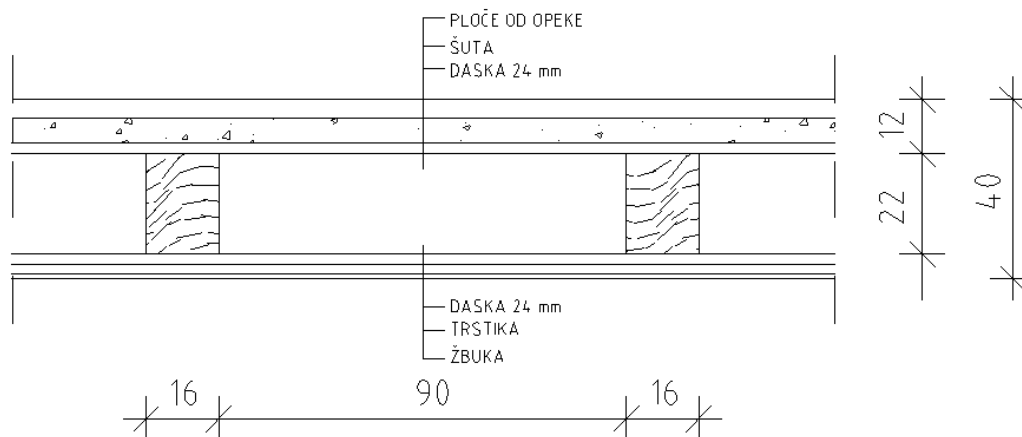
Prikaz stropne konstrukcije iznad dijela prizemlja
